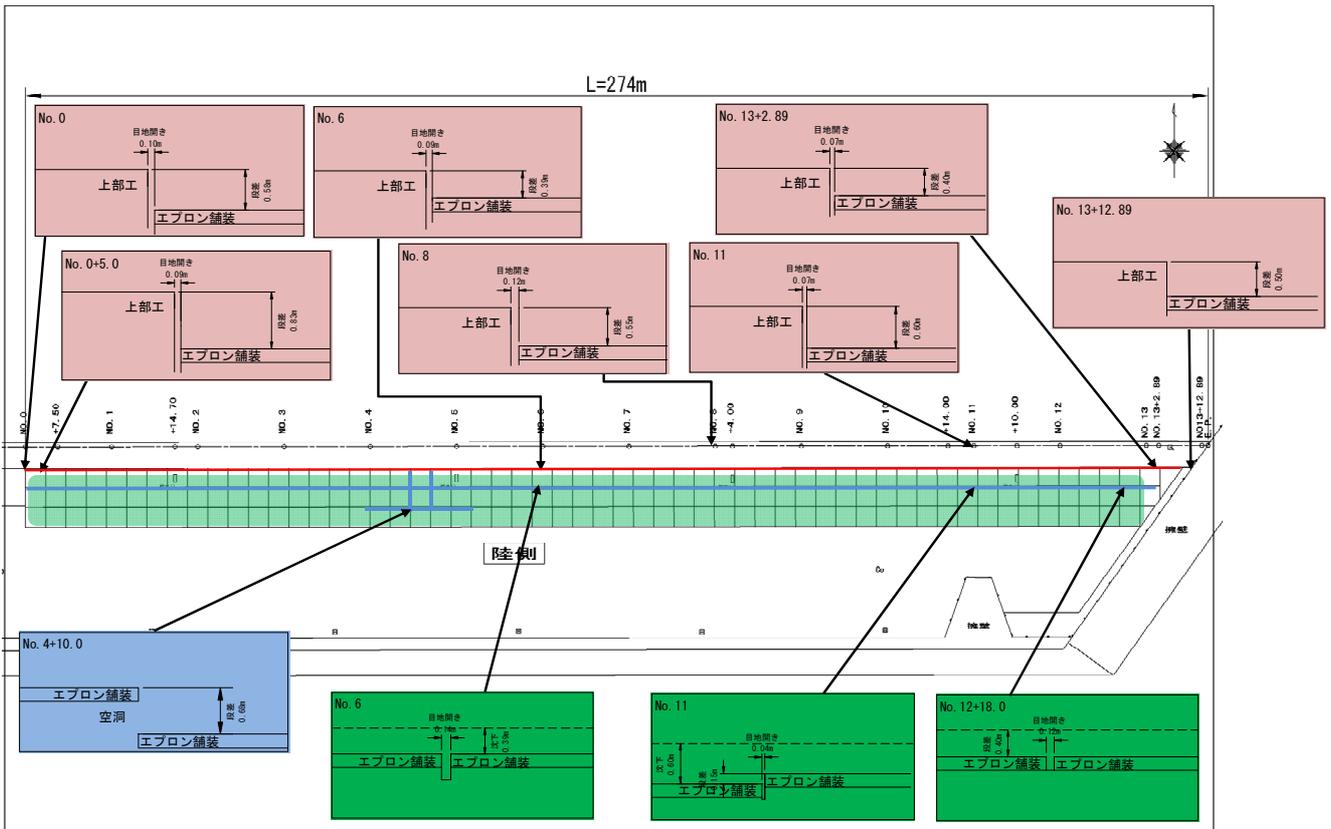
No.23 常陸那珂港区_南ふ頭地区 C岸壁 (-7.5m) の平面図 (被災後)
